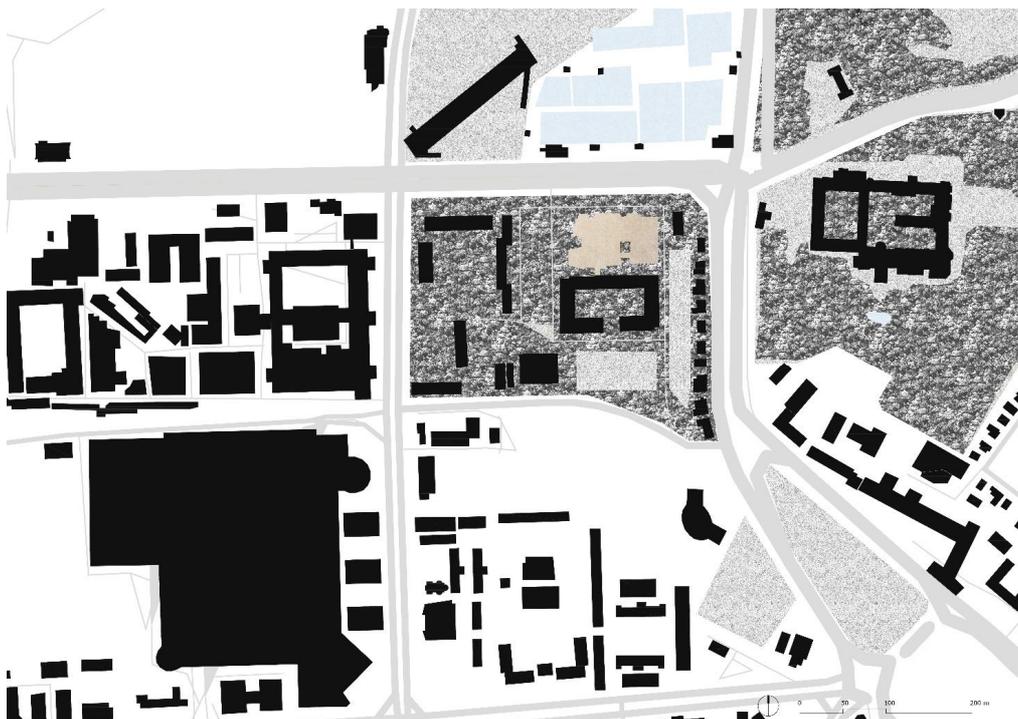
Ex-Accademia "Stefan Gheorghiu". Planimetria. [Ridisegno dell'autore]
